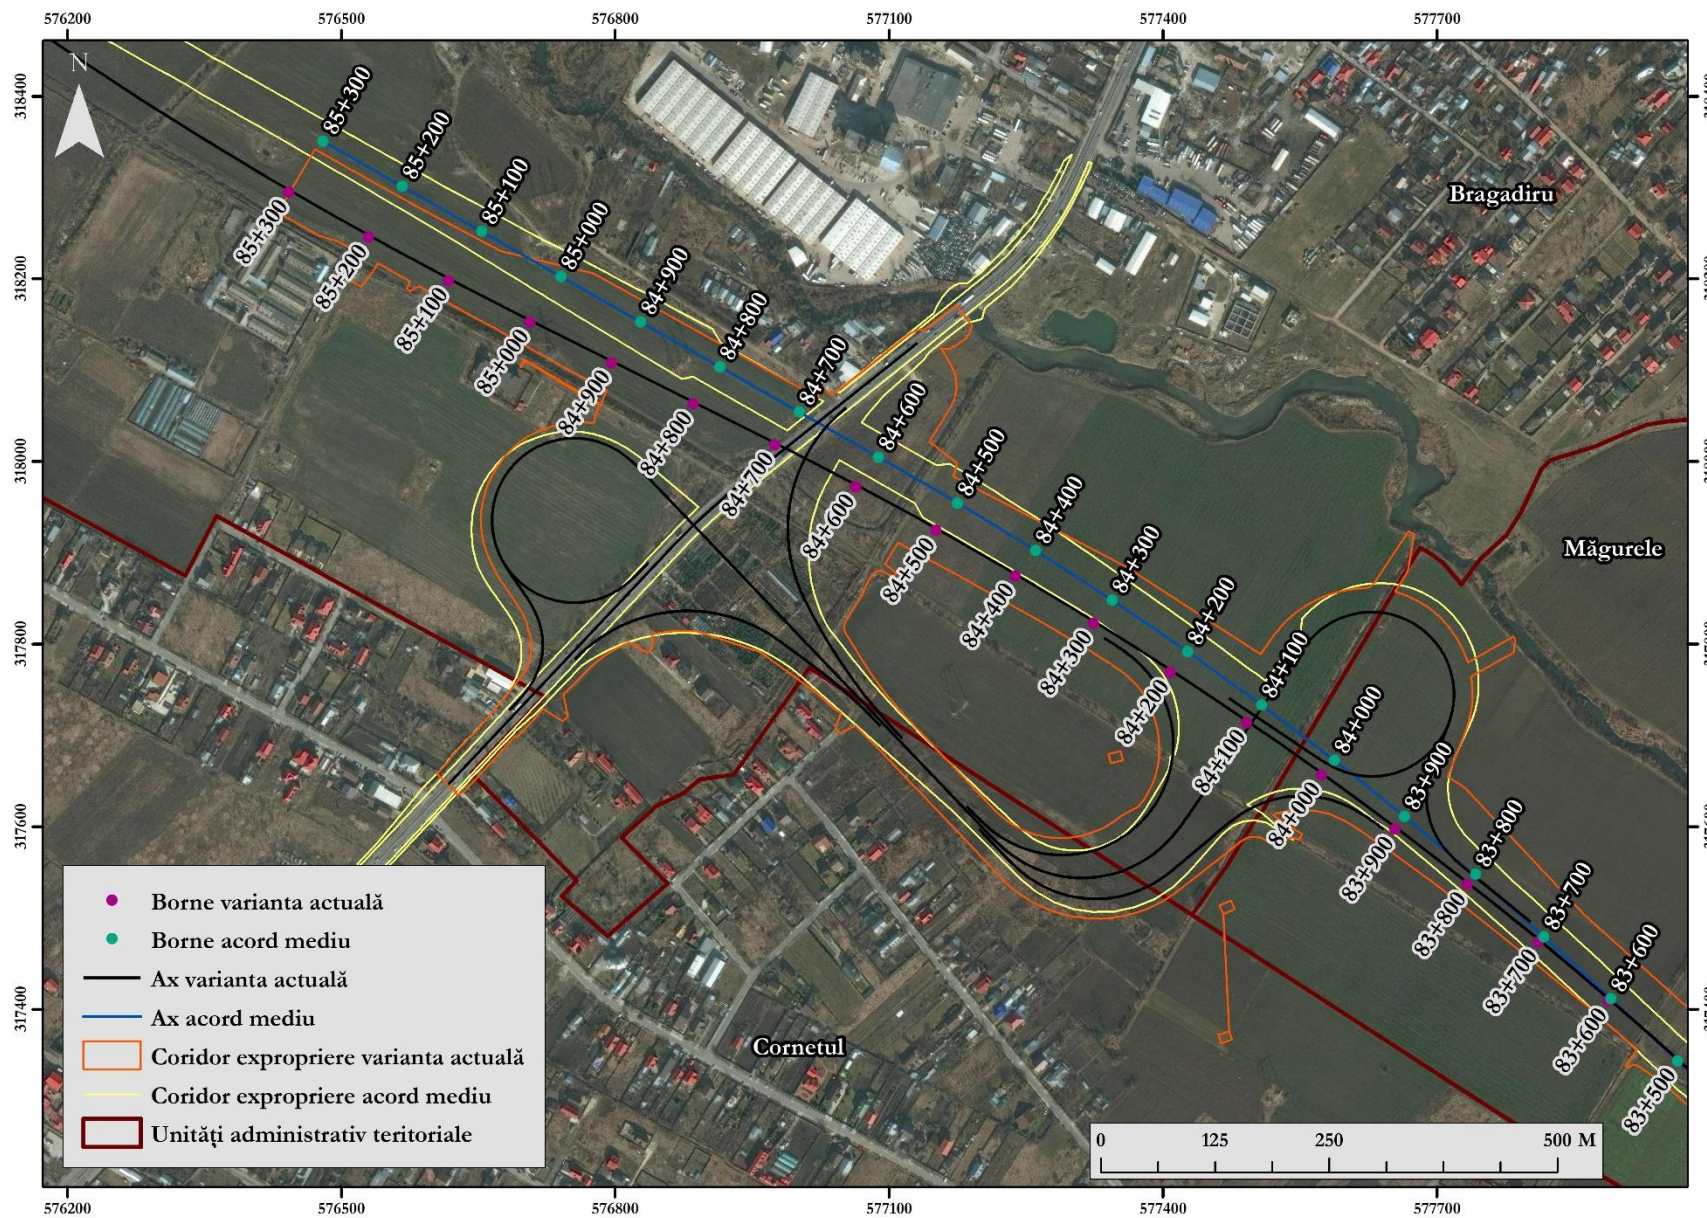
Modificarea traseului în plan propusă în zona Bragadiru (zona km 83+600 – km 85+300)
